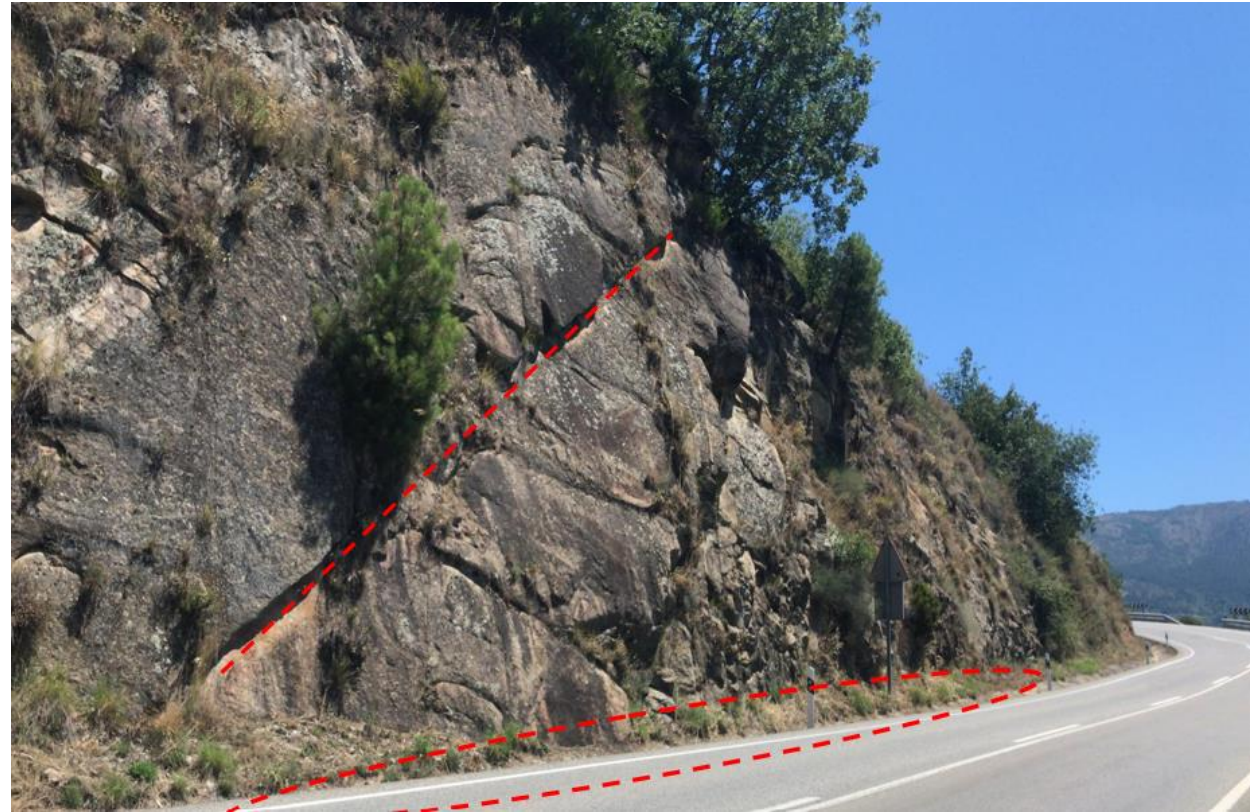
Plano de rotura. Talud en curva. Cuneta en pie de talud muy pequeña. Fuente: Propia.
